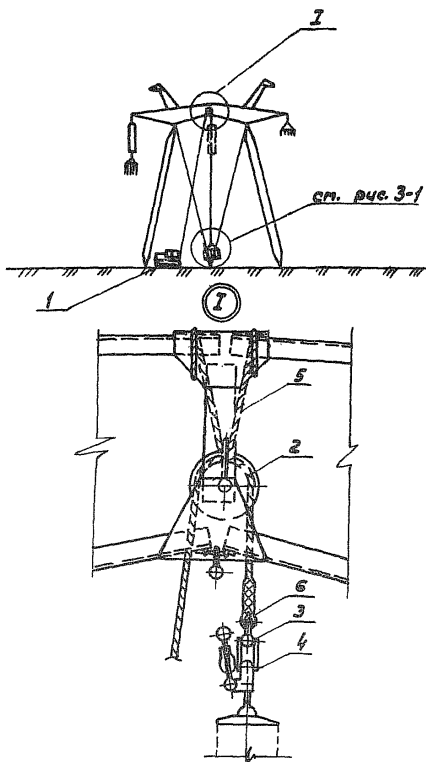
Перекладка проводов средней фазы с опусканием на землю.
